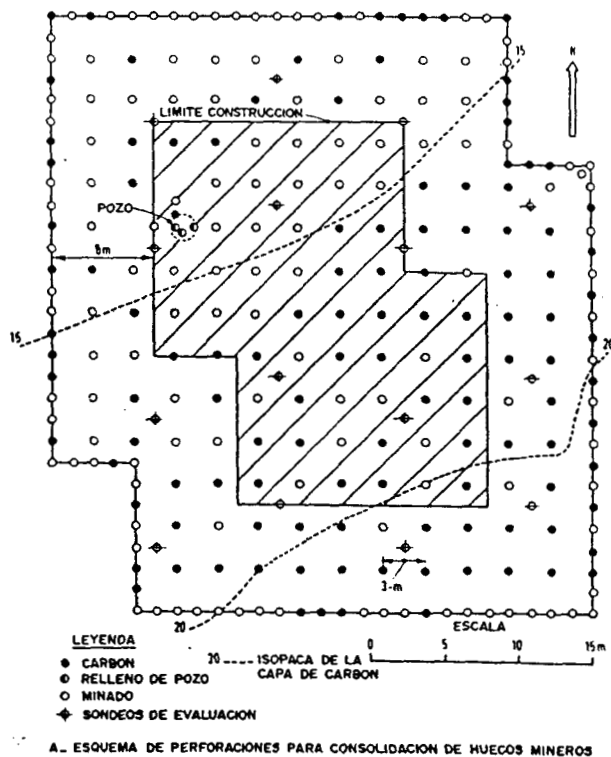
Construcción de barreras perimetrales para consolidación posterior. (Littlejohn, G. S.)
